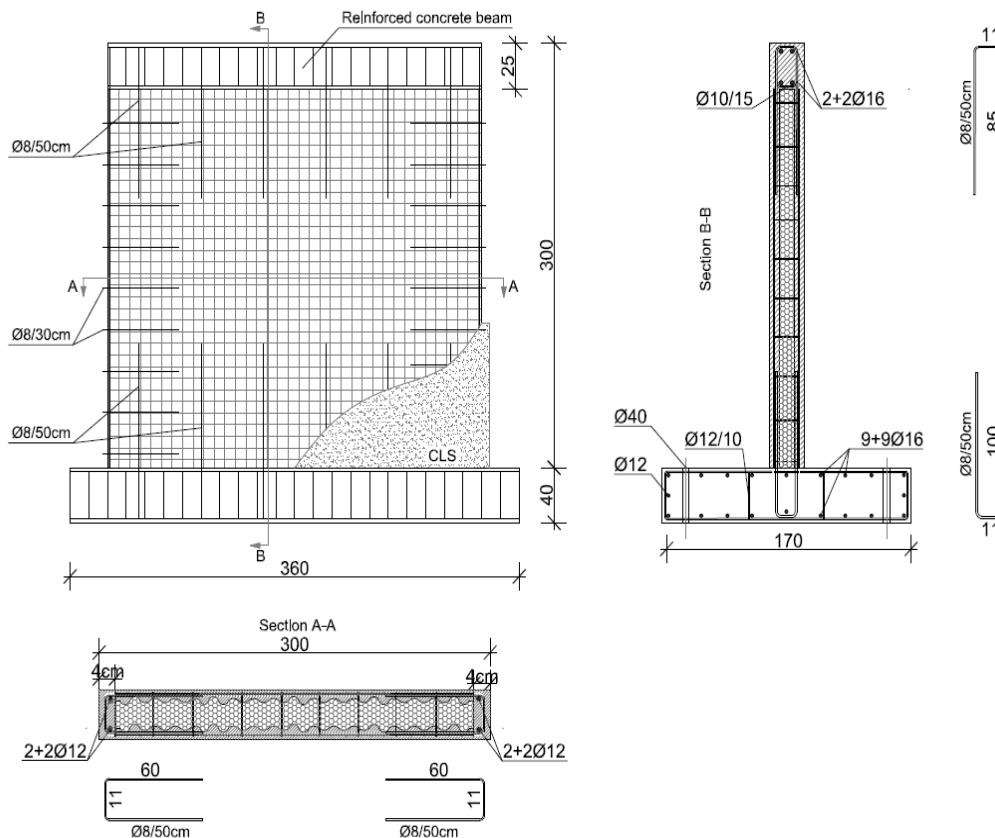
Dimensioni delle pareti provate e dettaglio delle armature.
